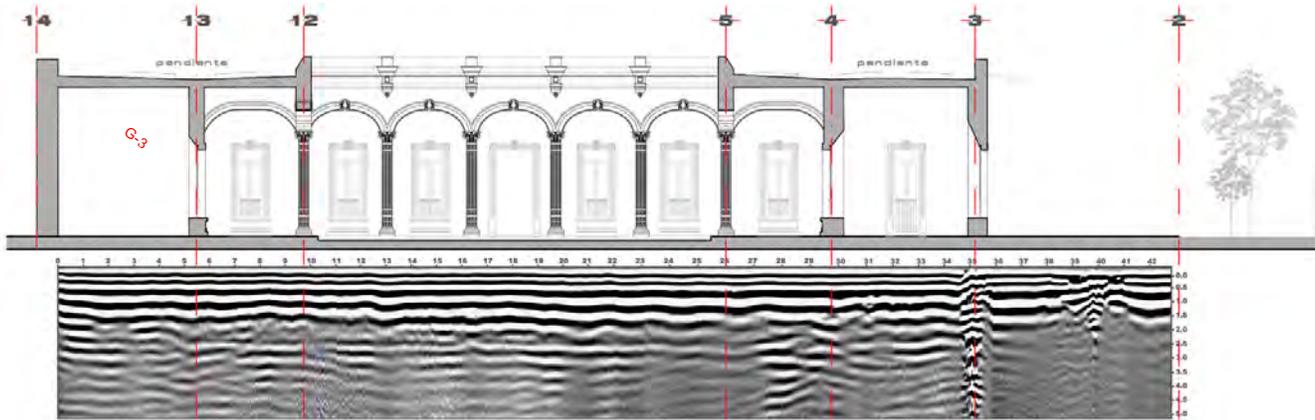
Alzado pasillo transversal del museo y perfil GPR-4. Fuente: Elaboración propia.
